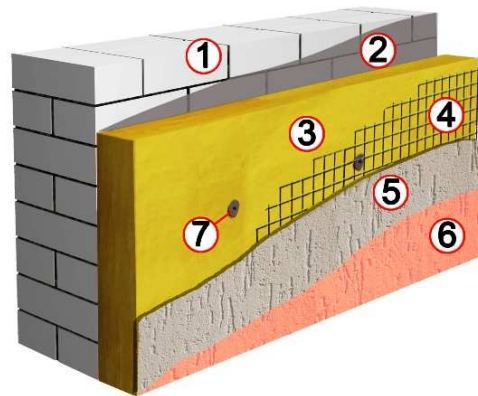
Схема утеплення фасаду "мокрим" методом:
